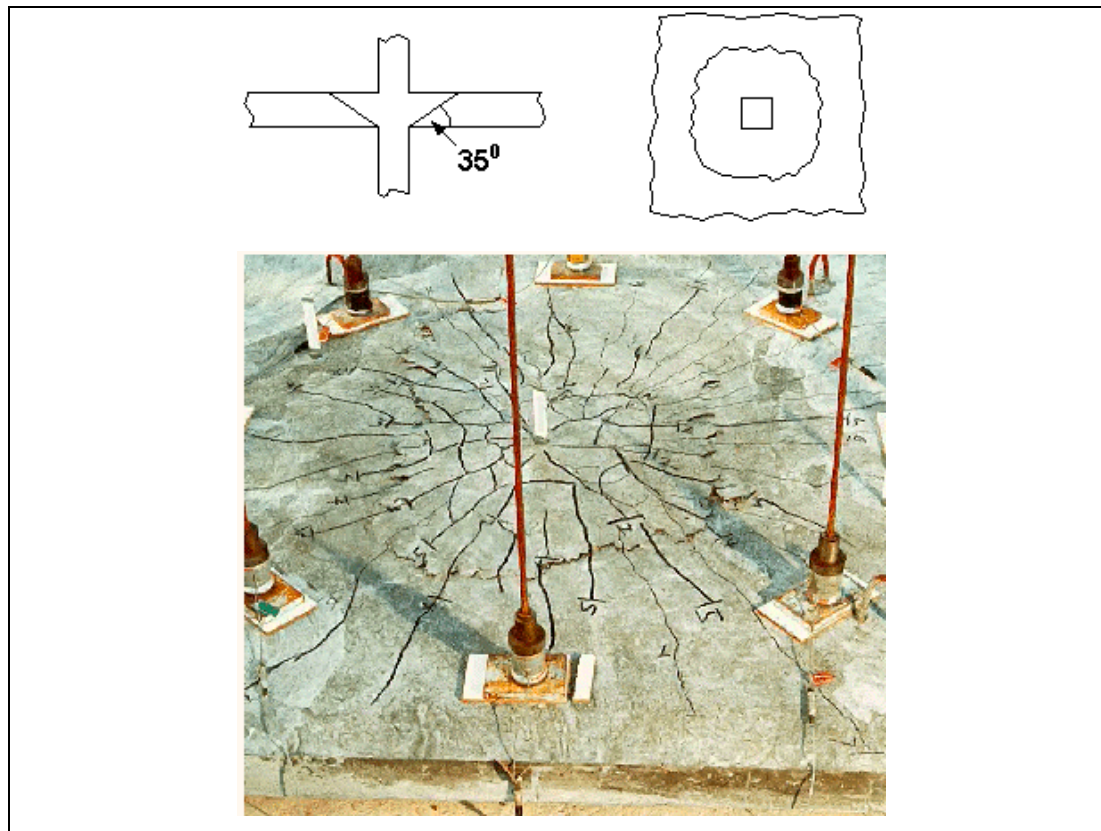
Geometria e configuração das fissuras provocadas por punção
